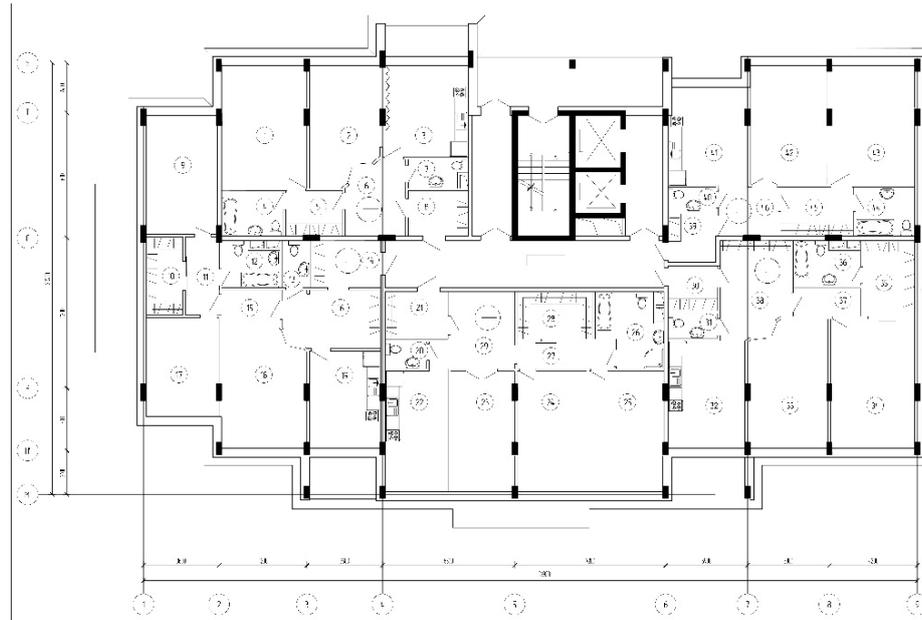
План 1 жилой секции на отметке 8,40 м. Функциональная схема плана 1 секции
